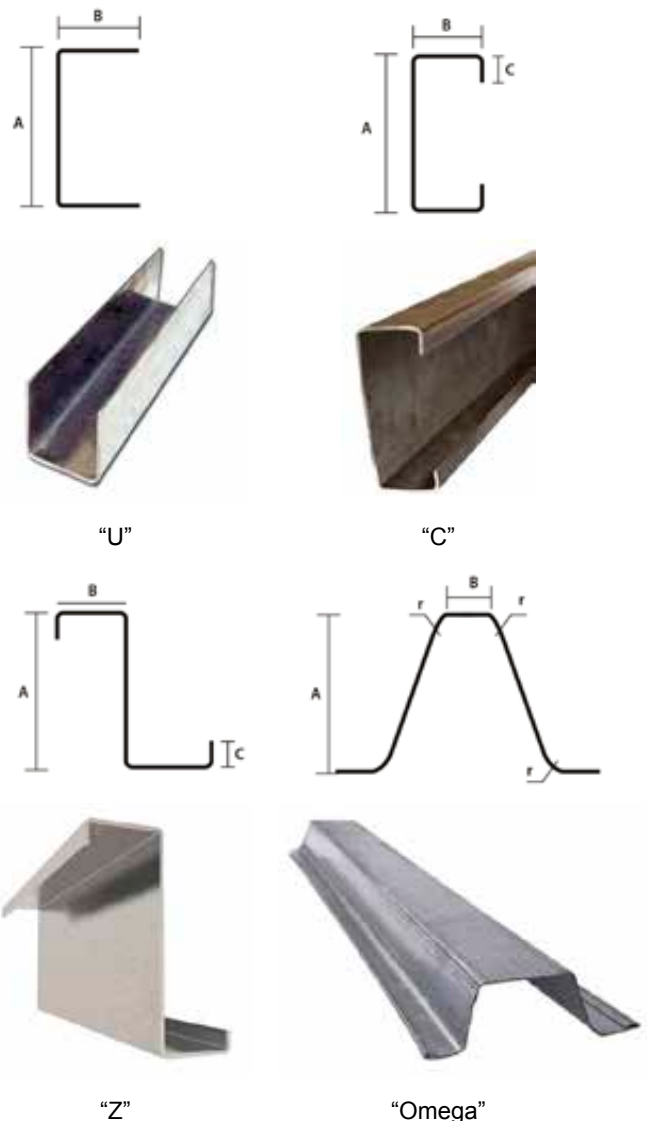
Tipos de perfiles de sección abierta conformados en frío y perfilados
